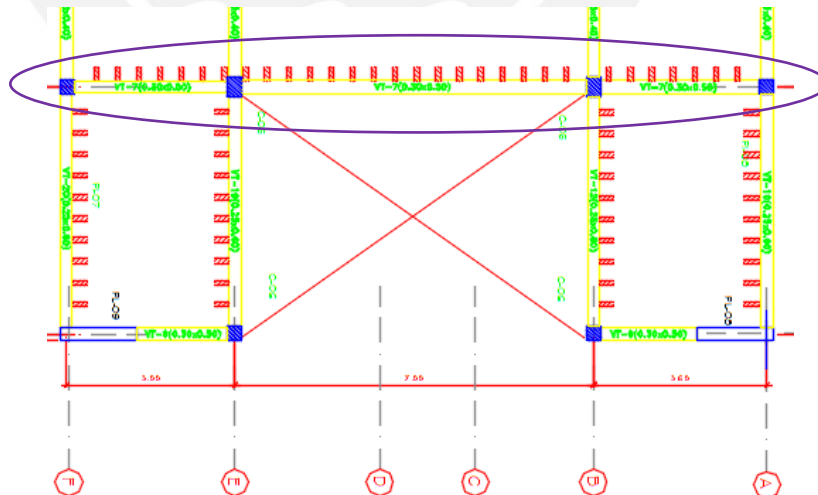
UBICACIÓN EN PLANTA DE LA VIGA VT-7 30 x 50 CM.
